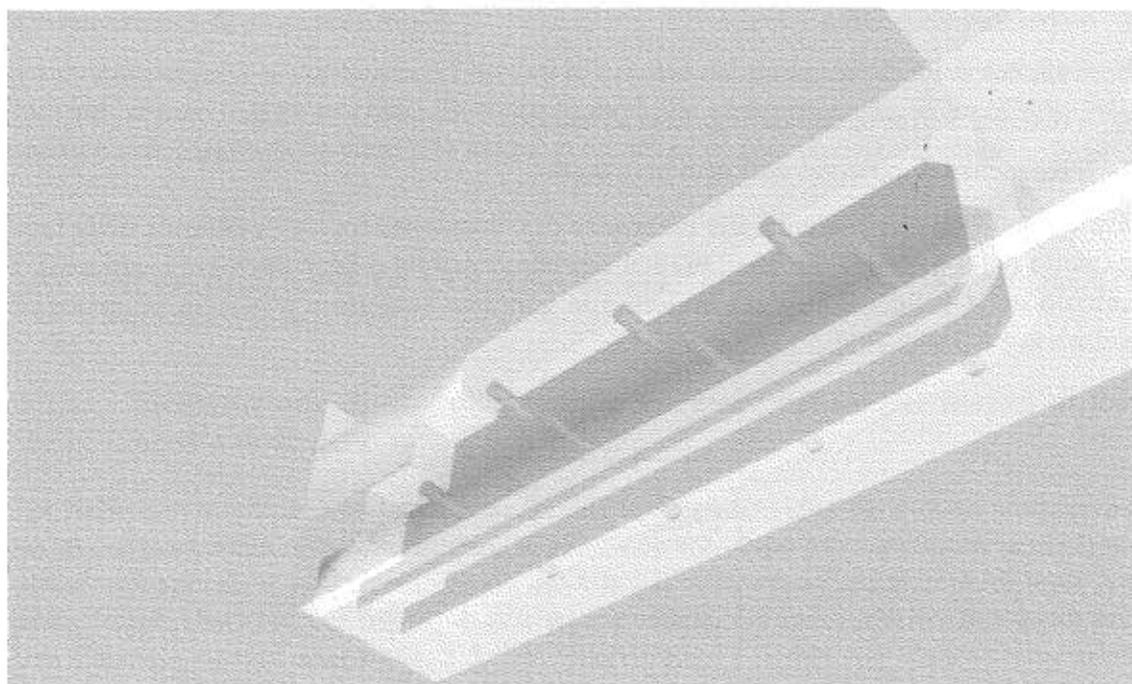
e – Ricostruzione dell'appoggio della trave con protesi costituita da profilati piatti d'acciaio. Fase 5: protesi con malta epossidica e chiusura dell'apertura sul muro con "aria" al contorno.
